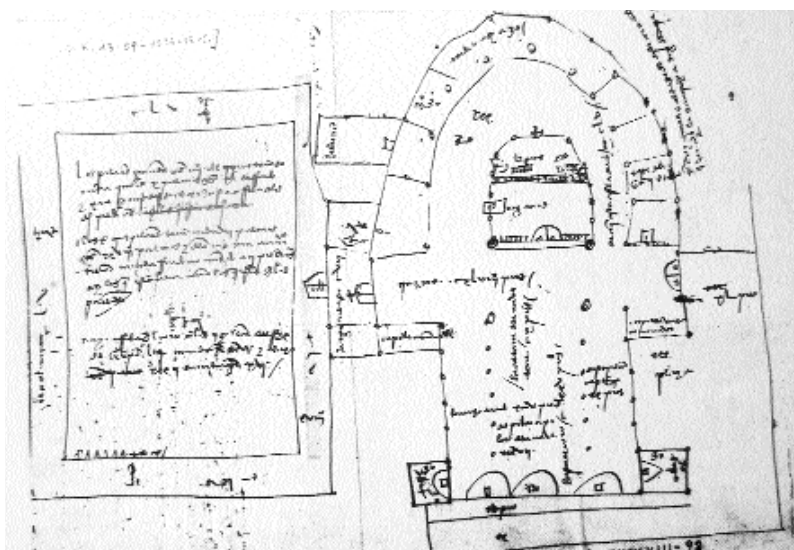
Catedral de León. Planta del conjunto en 1514 (Archivo de Simancas)
